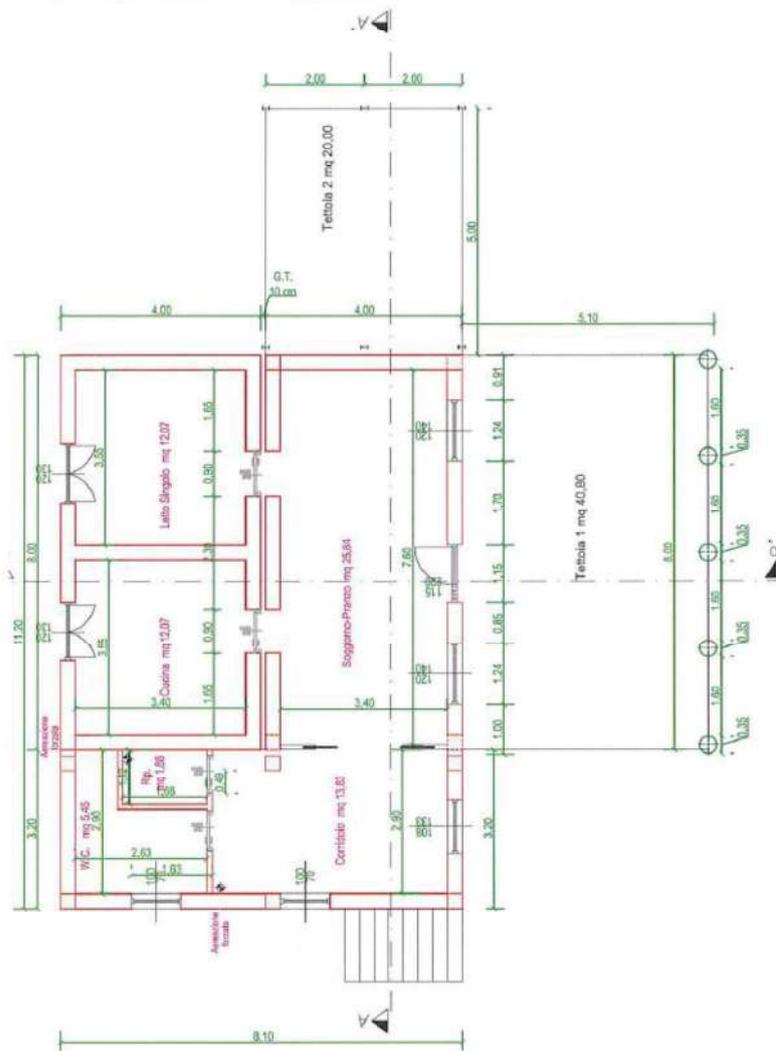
Pianta piano terra (F. ■ p.lla ■ sub. ■ allegata al "Permesso di Costruire n. ■ sub. ■ - Prot. n. ■ del 9.2.202122.7.2009"
